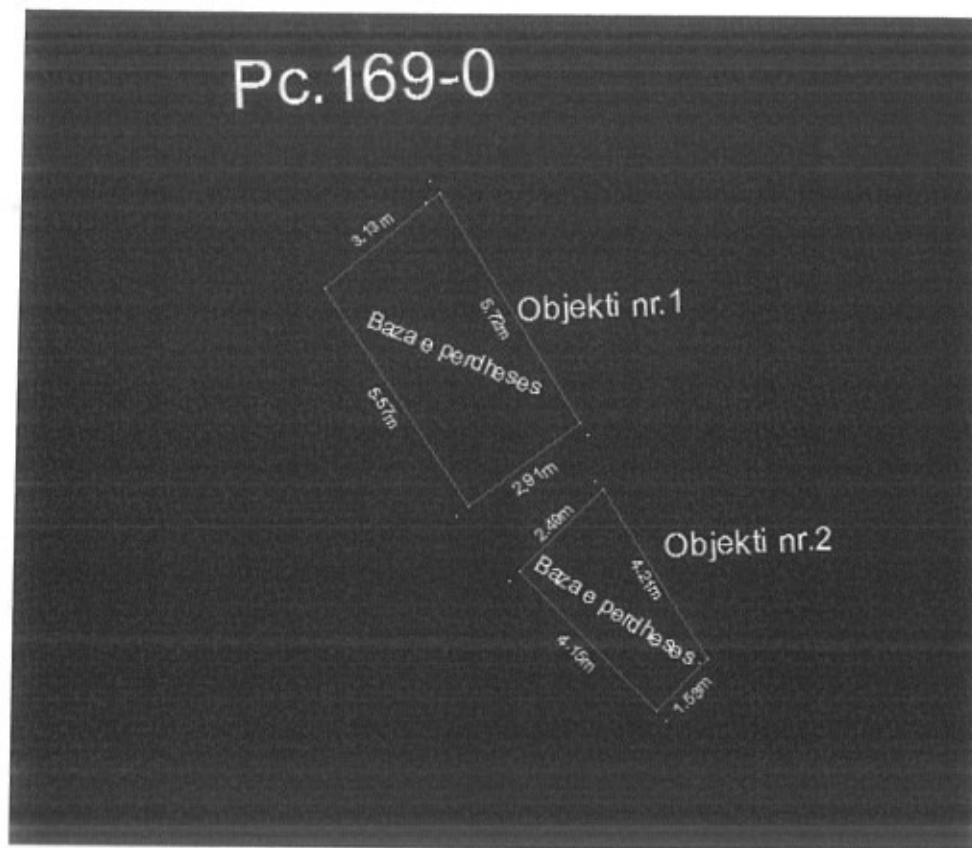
Dimensionet e përdhësave të objekteve afariste marr nga Formularit i Inqizimeve të Strukturës
